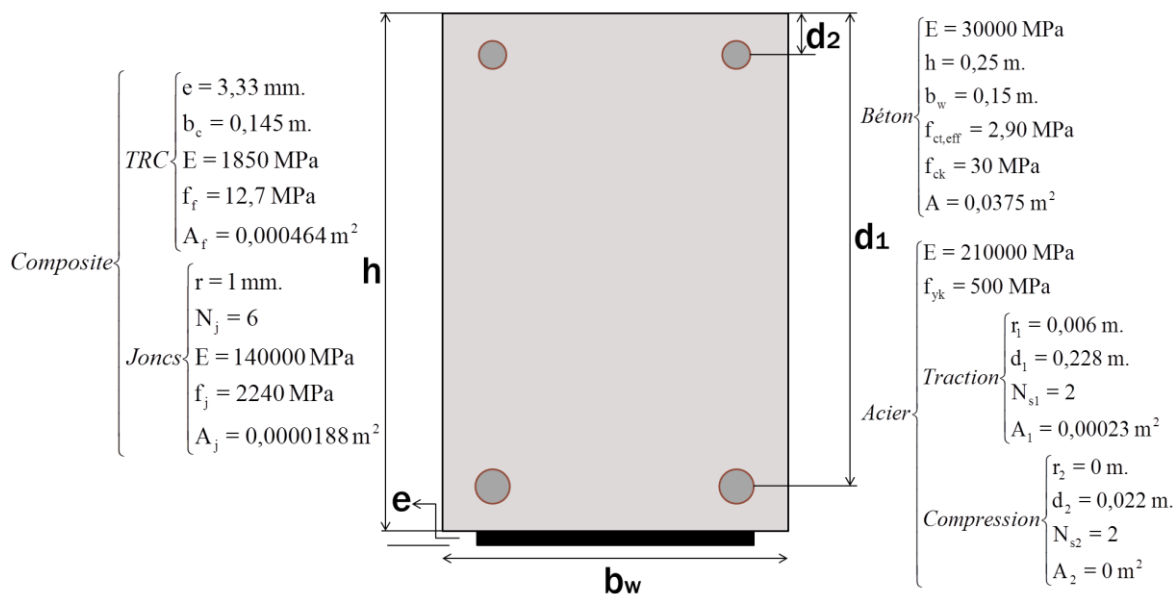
Propriétés mécaniques des matériaux de la section de la poutre
